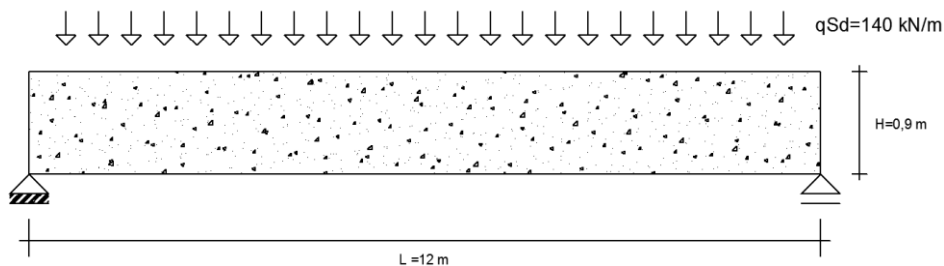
Vista lateral da viga de betão armado de secção retangular
